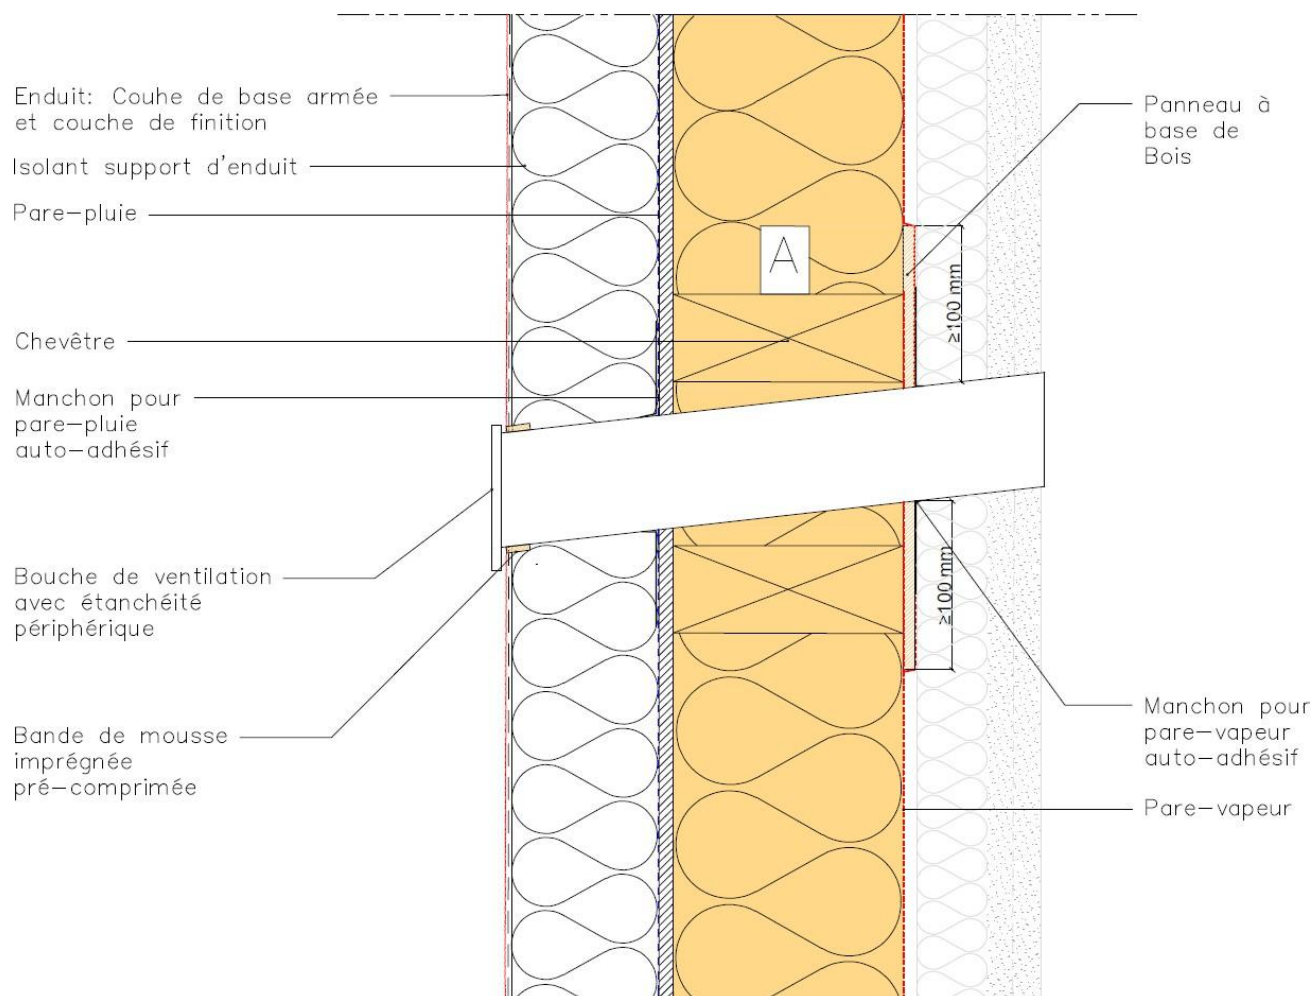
Traversée de paroi – Type orifice de ventilation - Coupe Verticale
